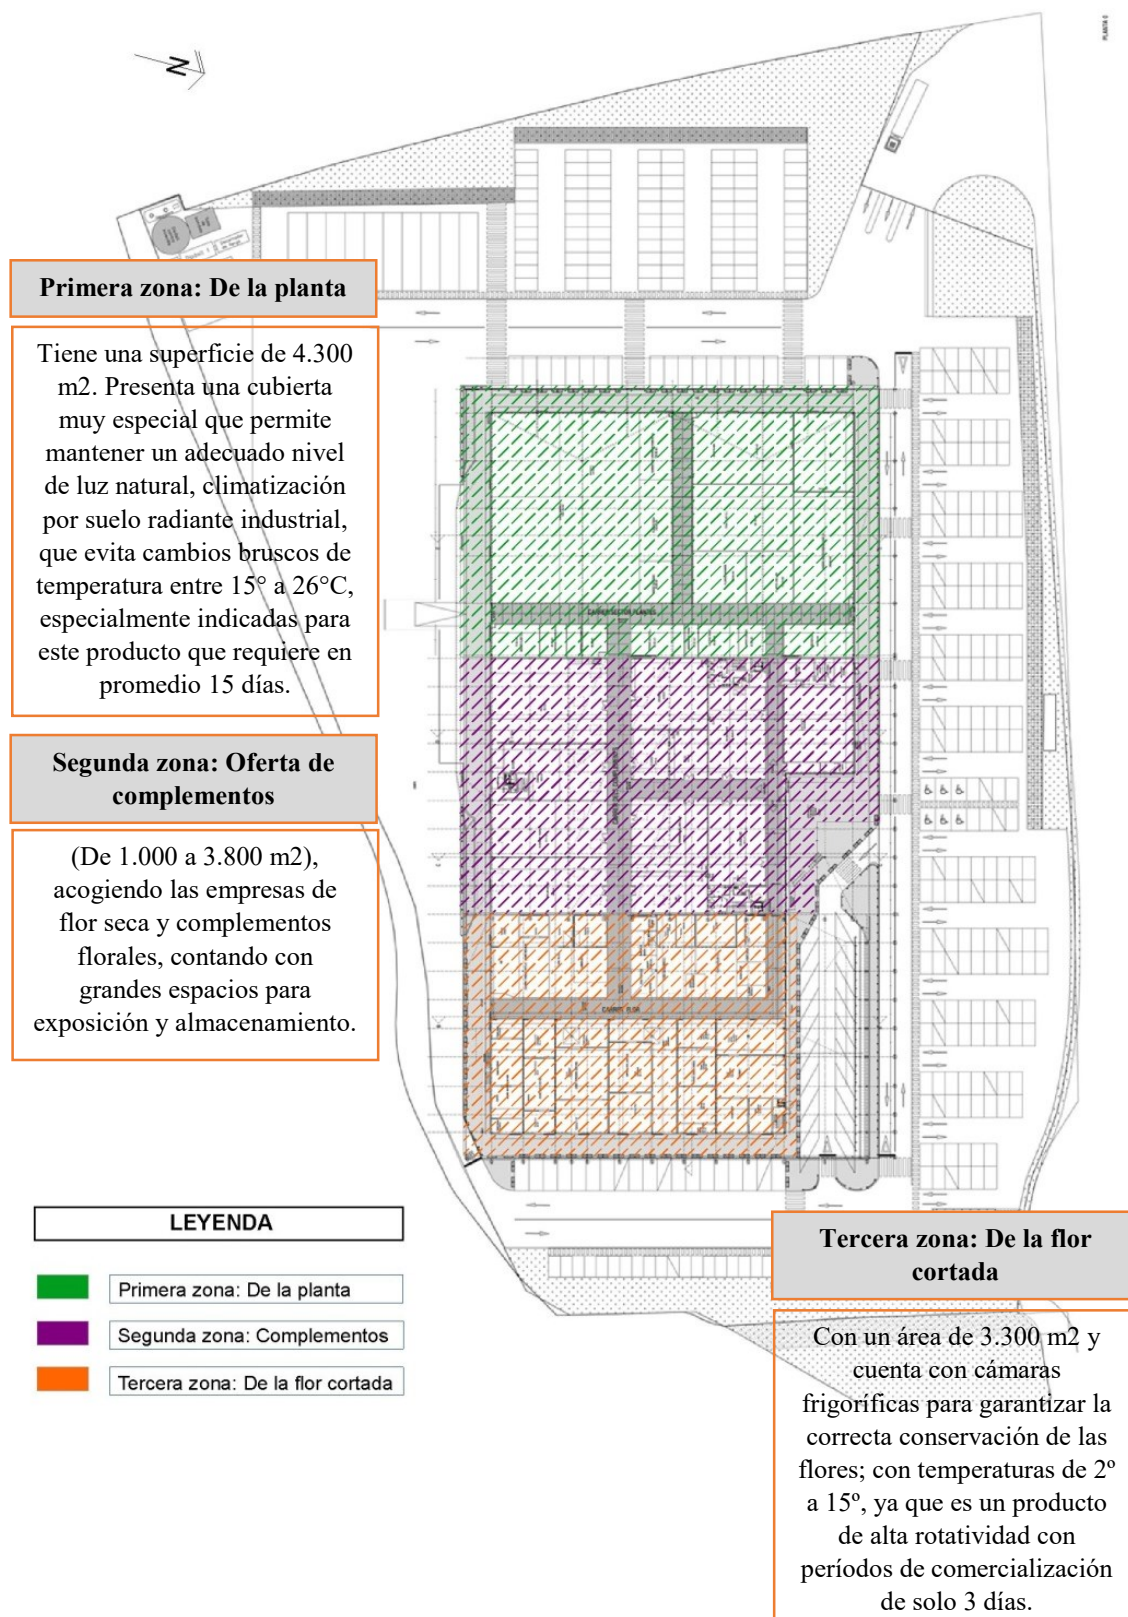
Zonificación, primer nivel Mercado Central de la Flor
